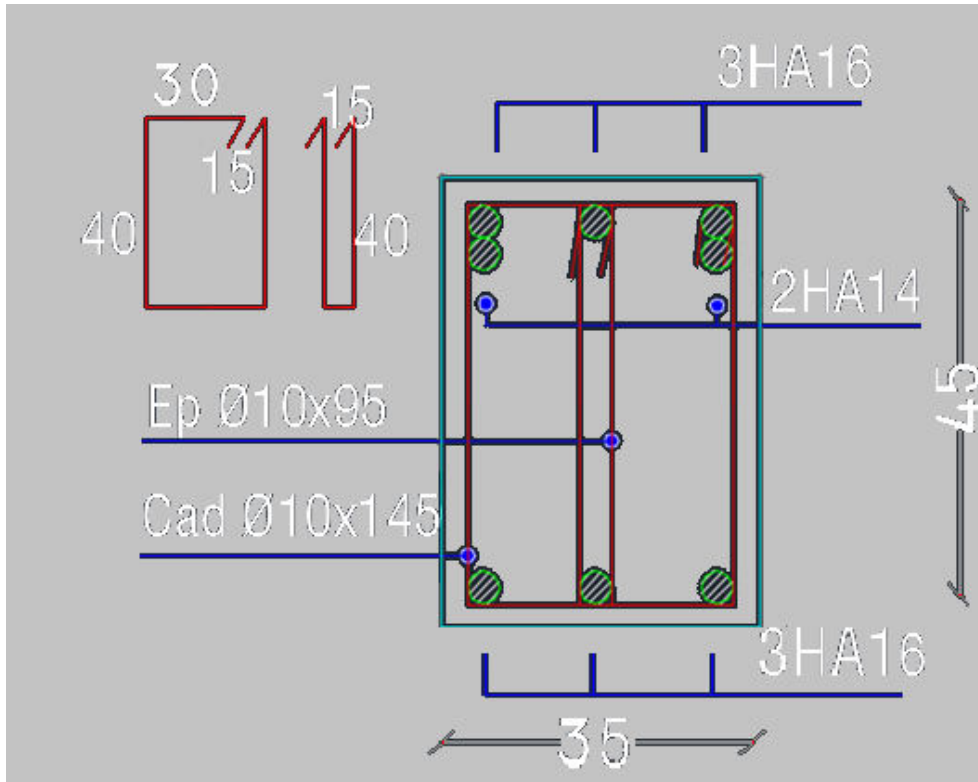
Ferrailage des poutres principales au niveau d'appuis de 8<sup>ème</sup> à 13<sup>ème</sup> étage.
